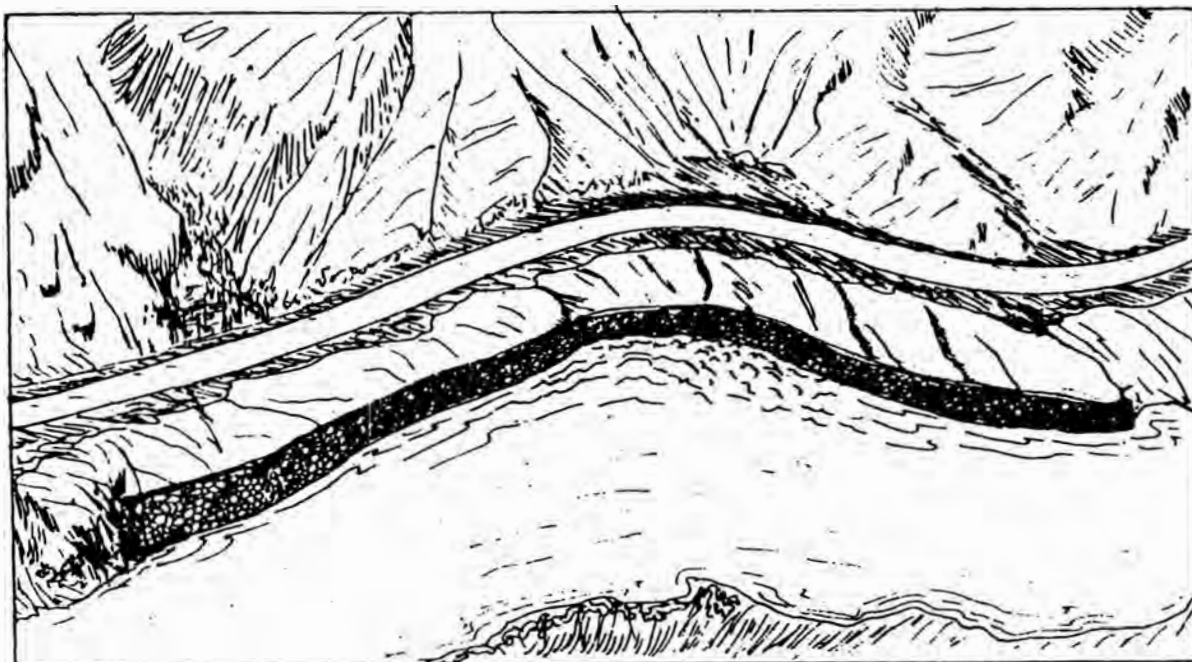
Protección del talud inferior de la vía con un muro de mampostería.
